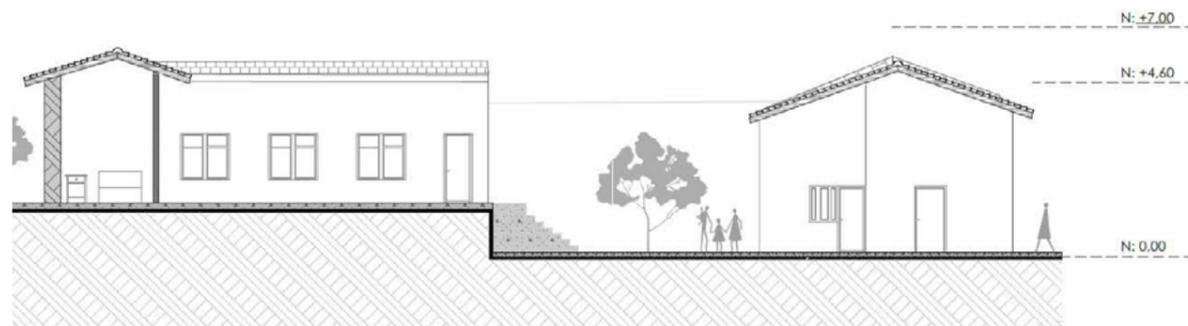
Alzado parte antigua Fuente: Elaboración propia
